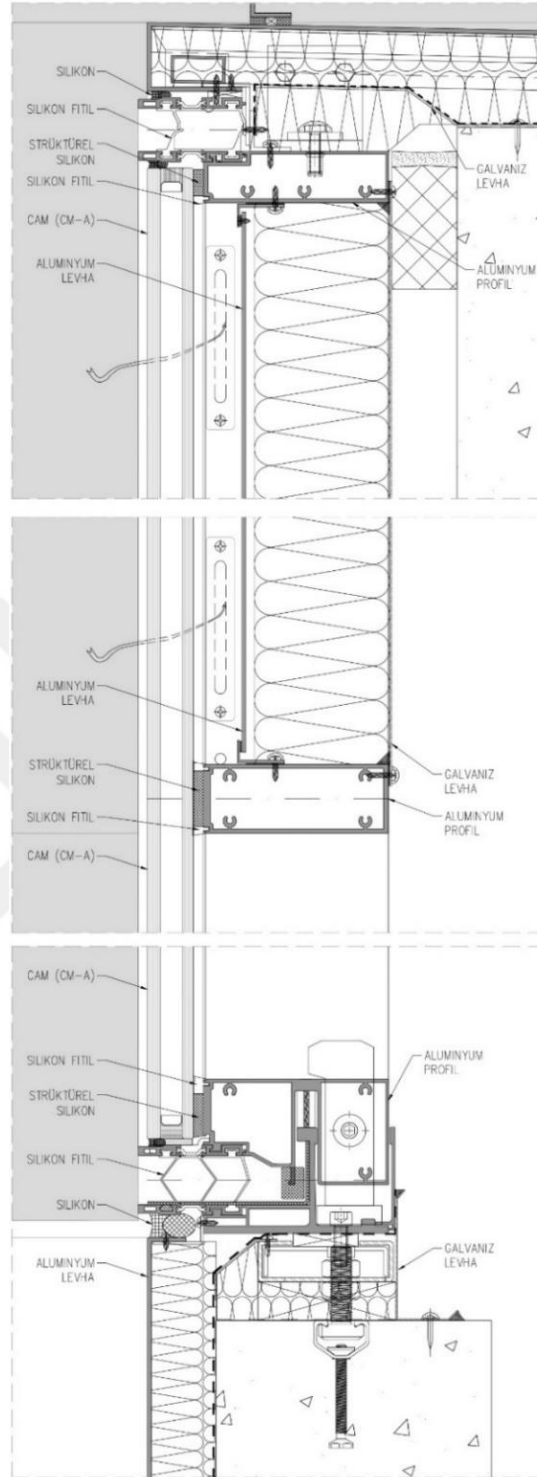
PNL-1 sisteminin plan, kesit ve görünüşü
